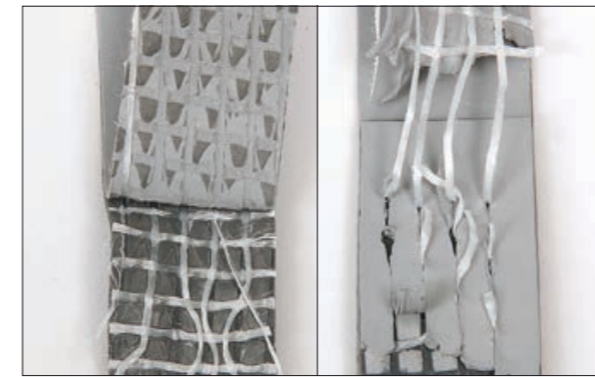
Когезионный разрыв сварного шва
